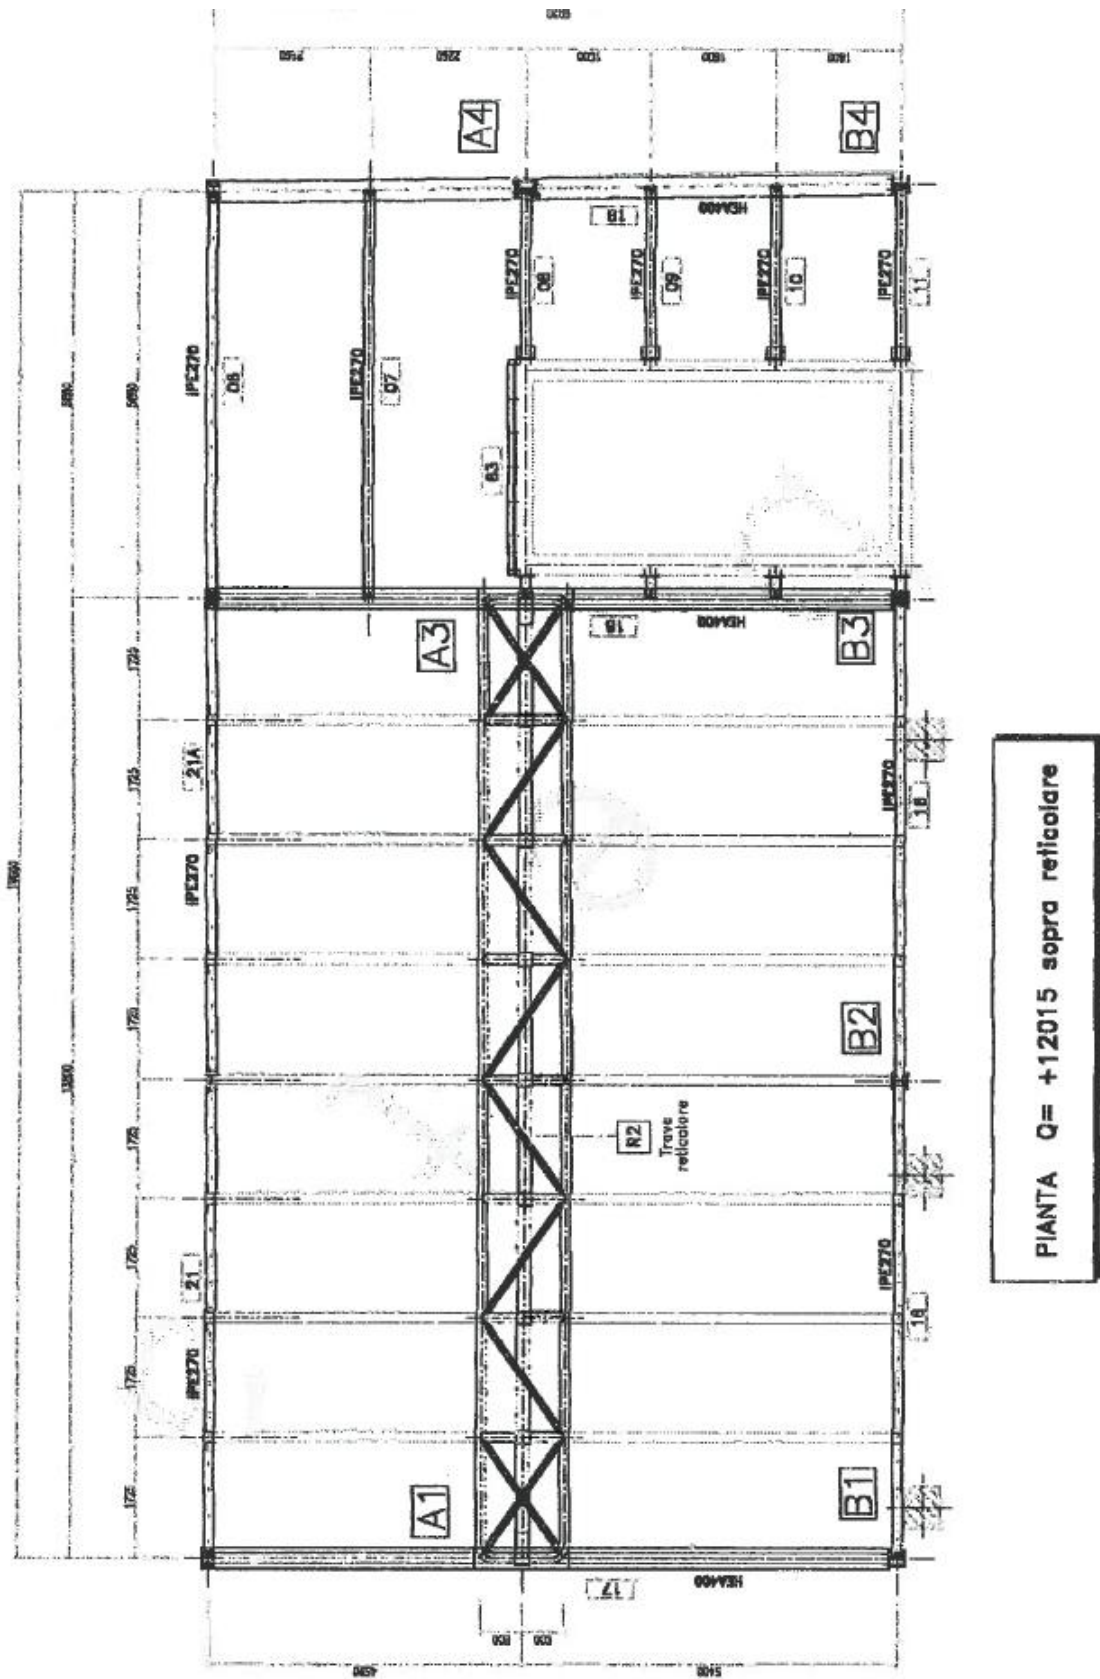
Particolare di A.2003.a.us.c.T12 - Pianta generali - Pianta piano secondo
